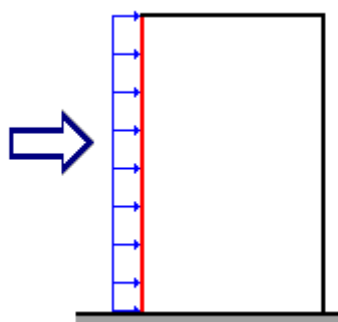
Расчетная схема определения ветровой нагрузки на наветренную поверхность.
